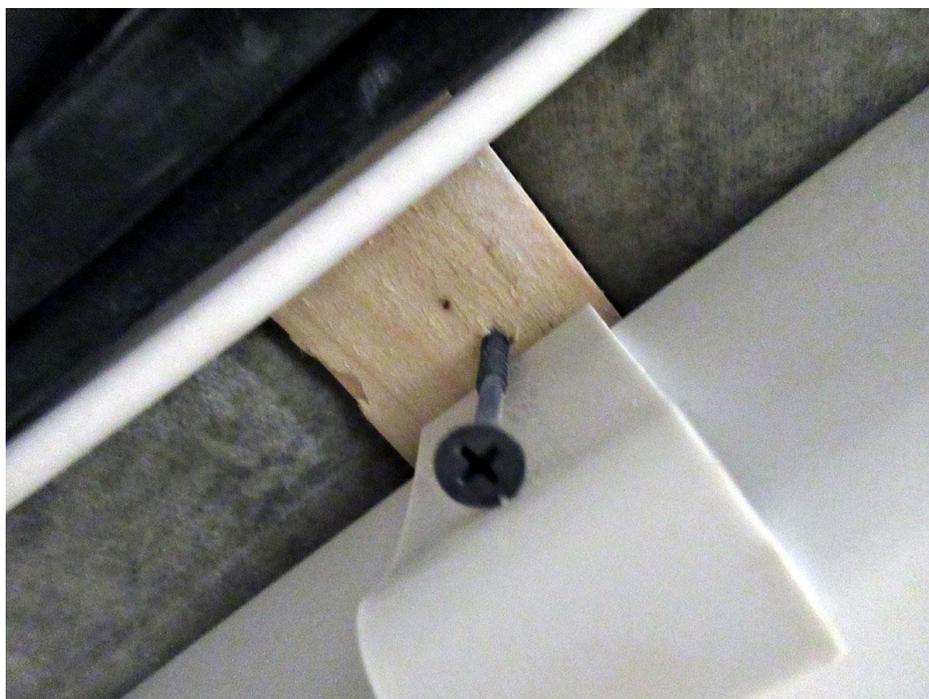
Смонтированная системы вентиляции не закреплена надлежащим образом, фасонные элементы и воздуховоды системы вентиляции смонтированы между собой на бумажный скотч
